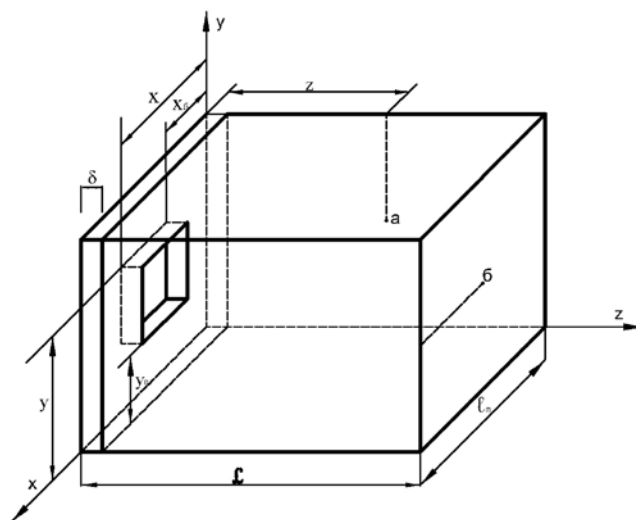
Схема расположения расчетных точек по отношению к световому проему: а – на боковой стенке; б – на задней стенке
